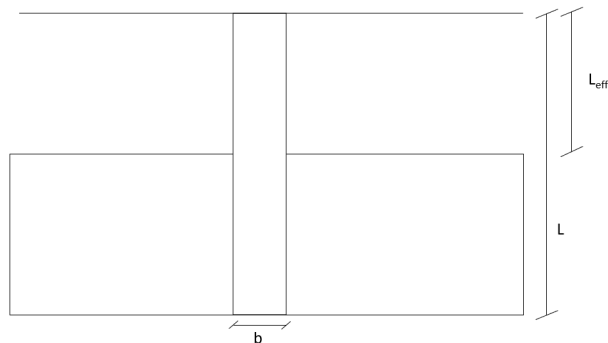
Geometría típica de una columna corta de hormigón armado
